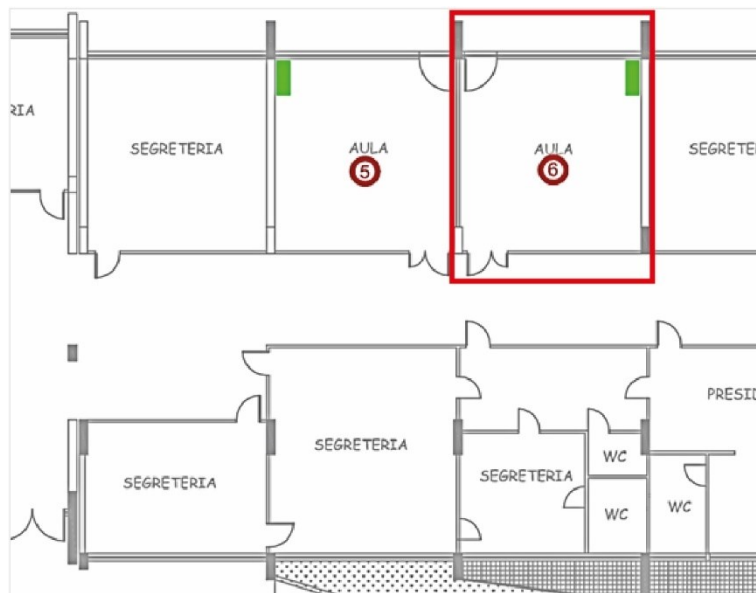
Porzione di planimetria al piano terra della scuola di Falconara che individua l'aula oggetto di studio
